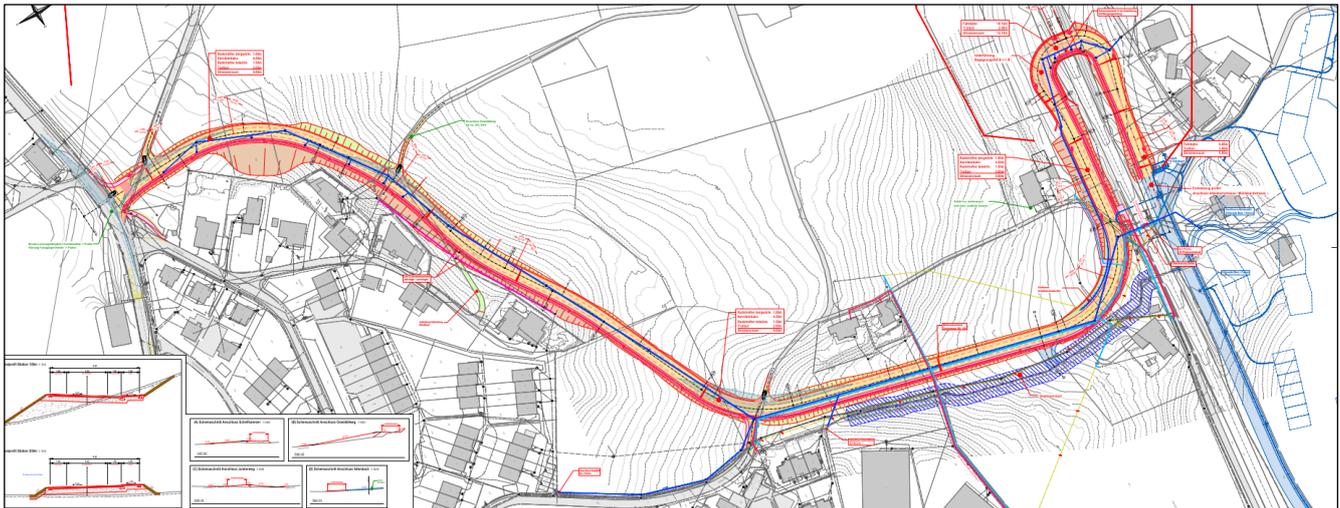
Geplante Junkerstrasse, Quelle: Machbarkeitsstudie Junkerstrasse, dat. 09.08.2024
